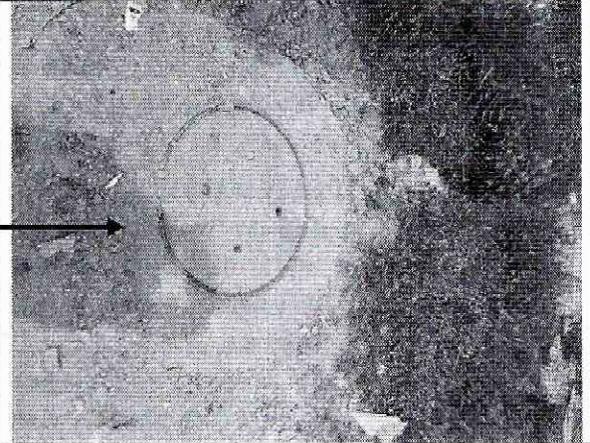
Pozo ubicado en la vía sobre la parte alta de la ladera.
